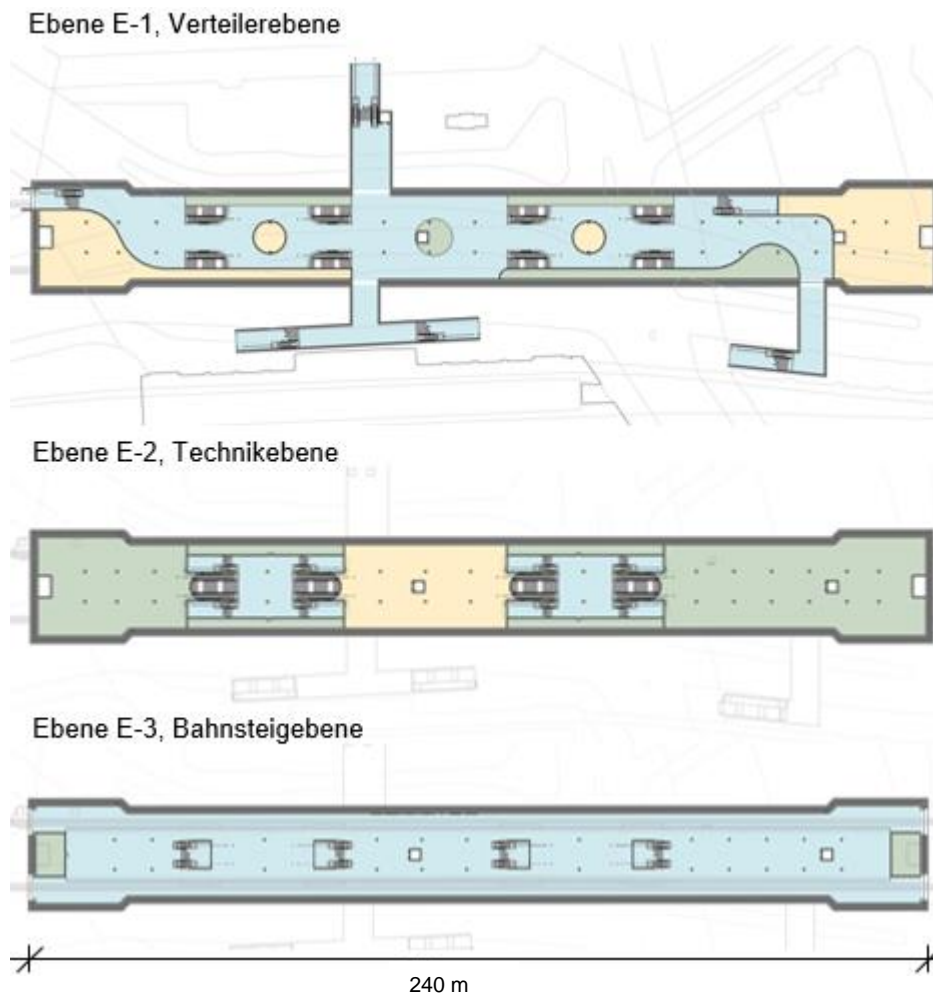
Hp Dammtor Var. I – Grundrisse
